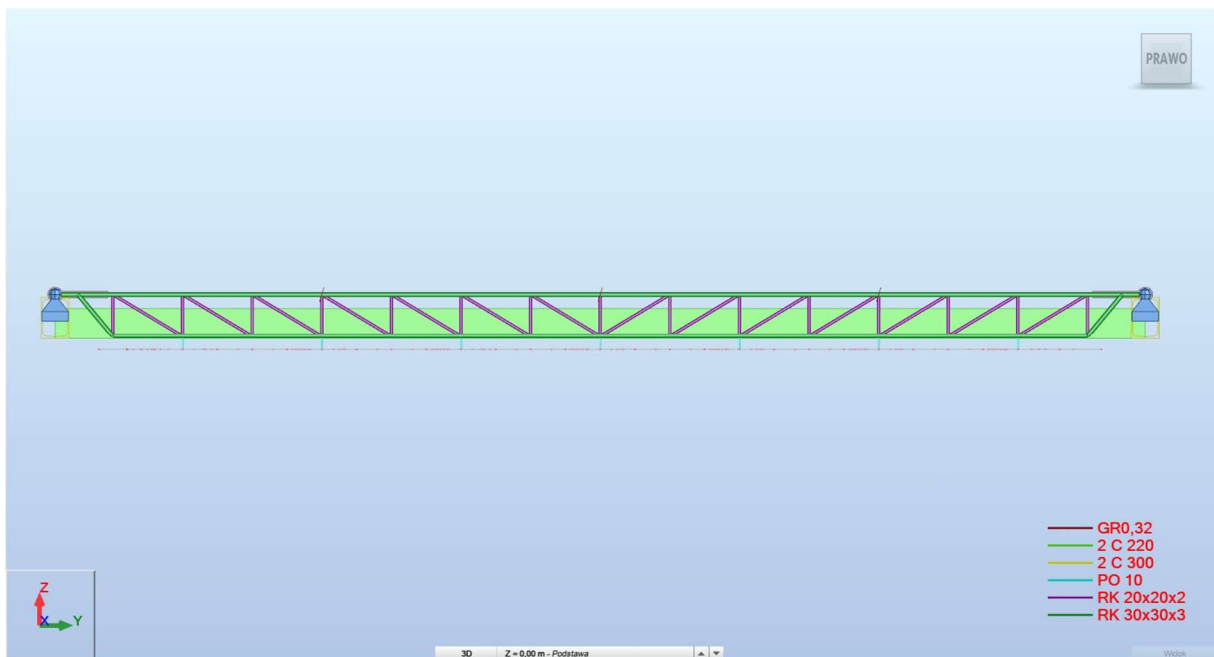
Konstrukcja wsporcza sufitu podwieszanego - model numeryczny 3D - widok 1
